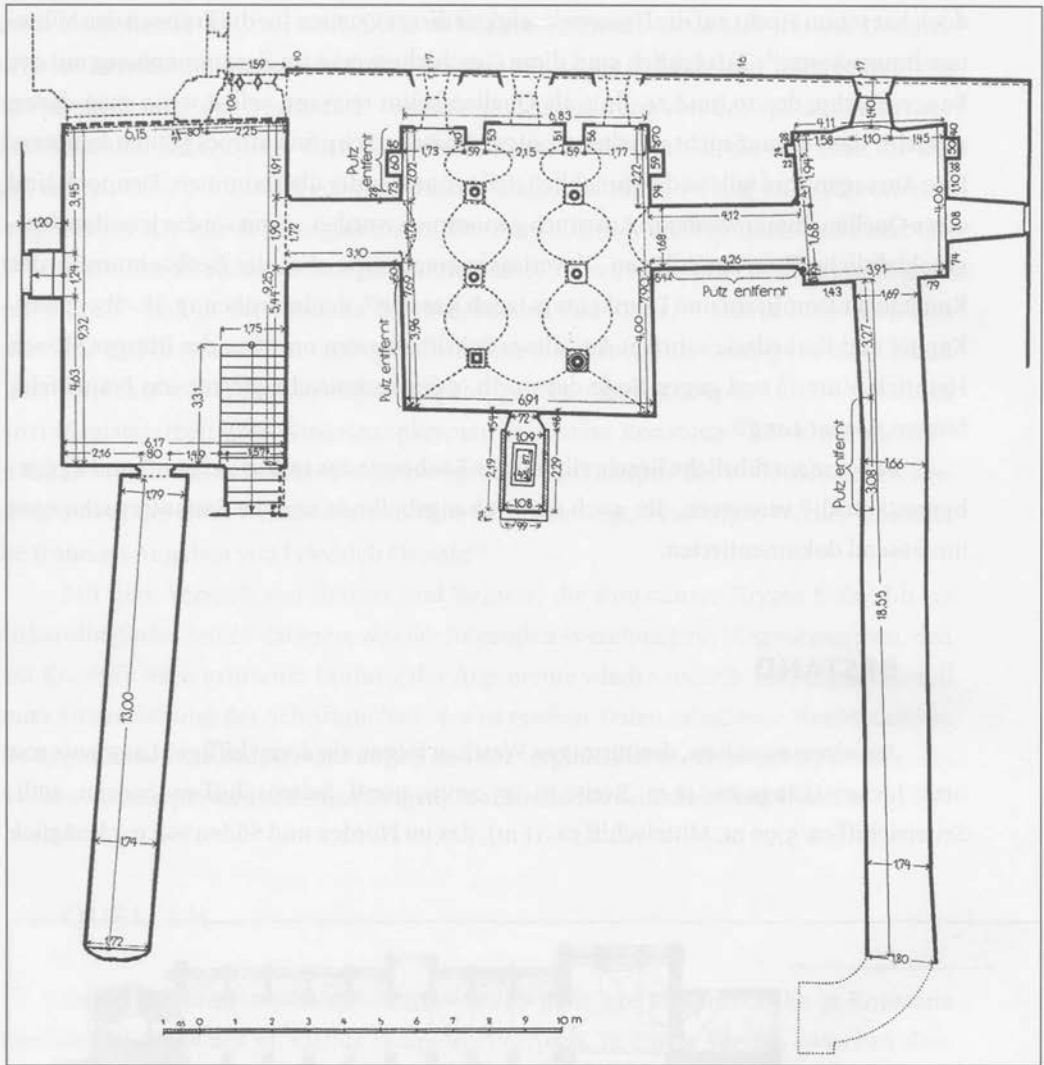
Grundriss der Krypta (Aufn. Reisser)
